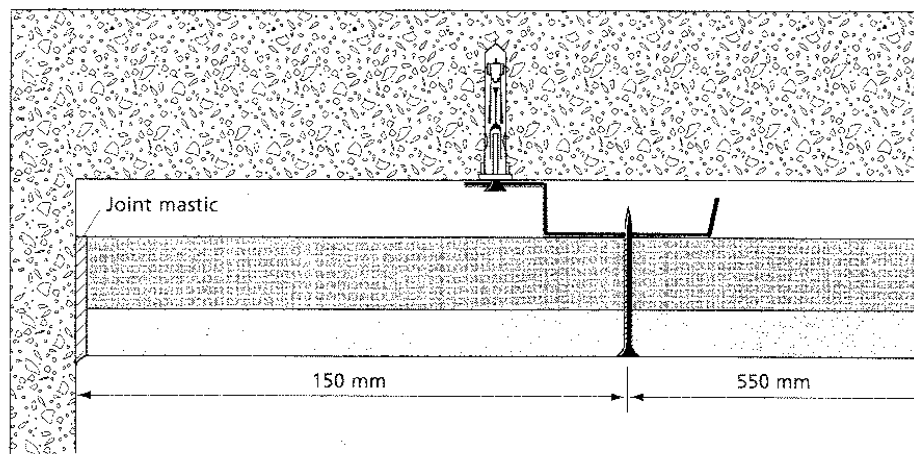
Jonction des ouvrages horizontaux ou inclinés avec les parois verticales (Cf. article 5.22 du dossier technique)- Coupe verticale sur profilé de rive
